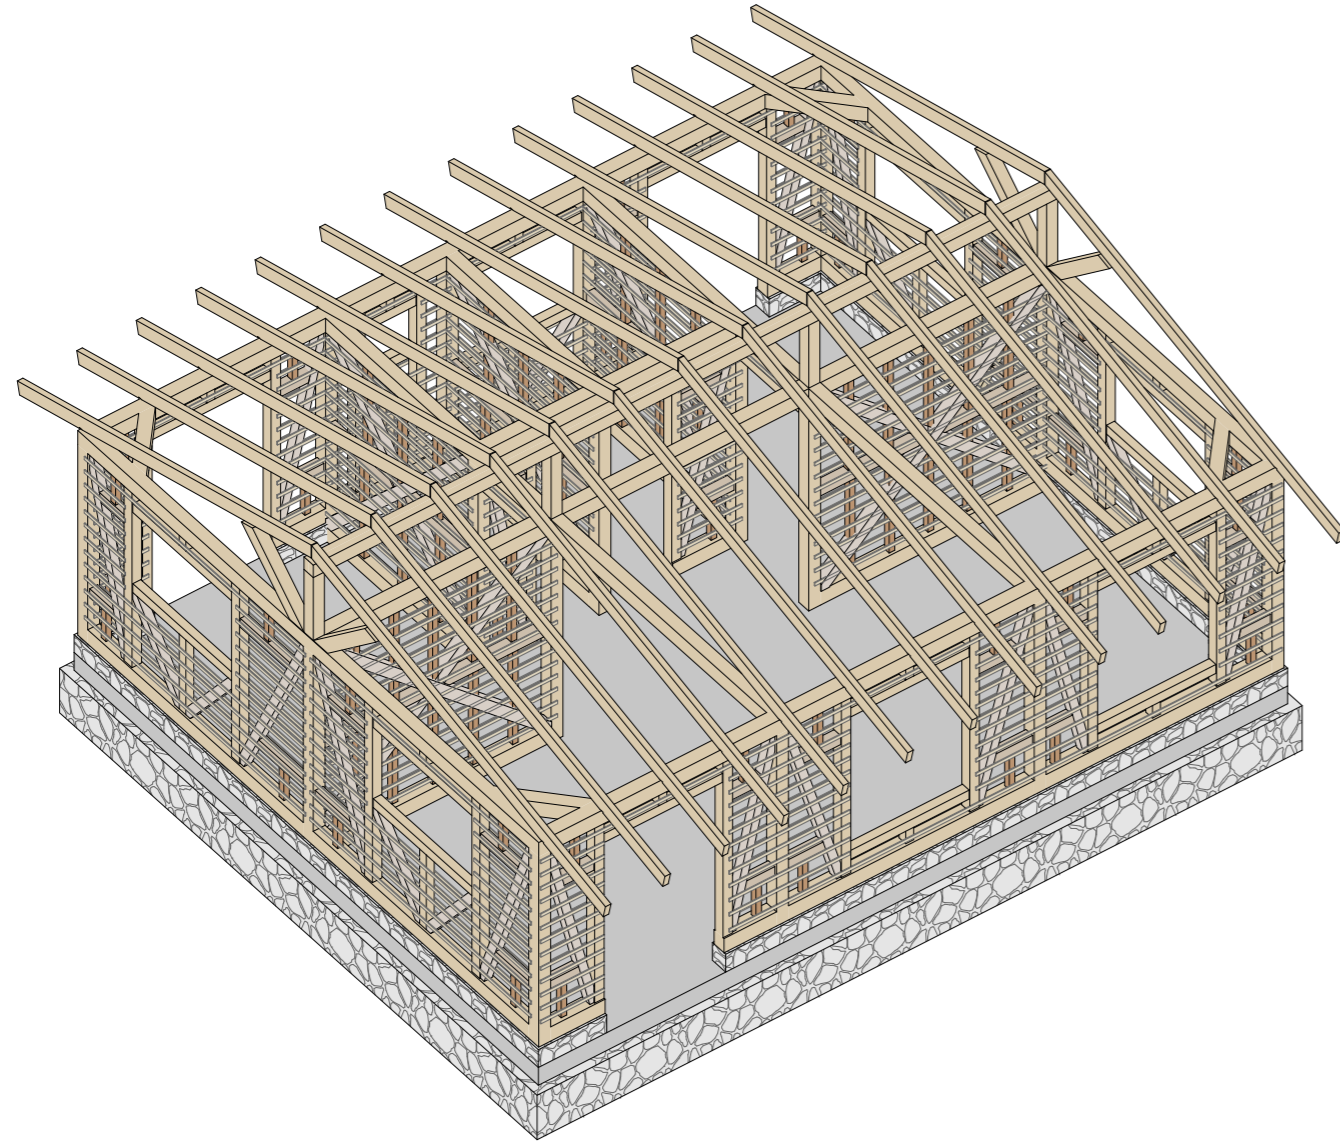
Axonometría de la estructura de la cubierta y de las varas entrelazadas en los muros
